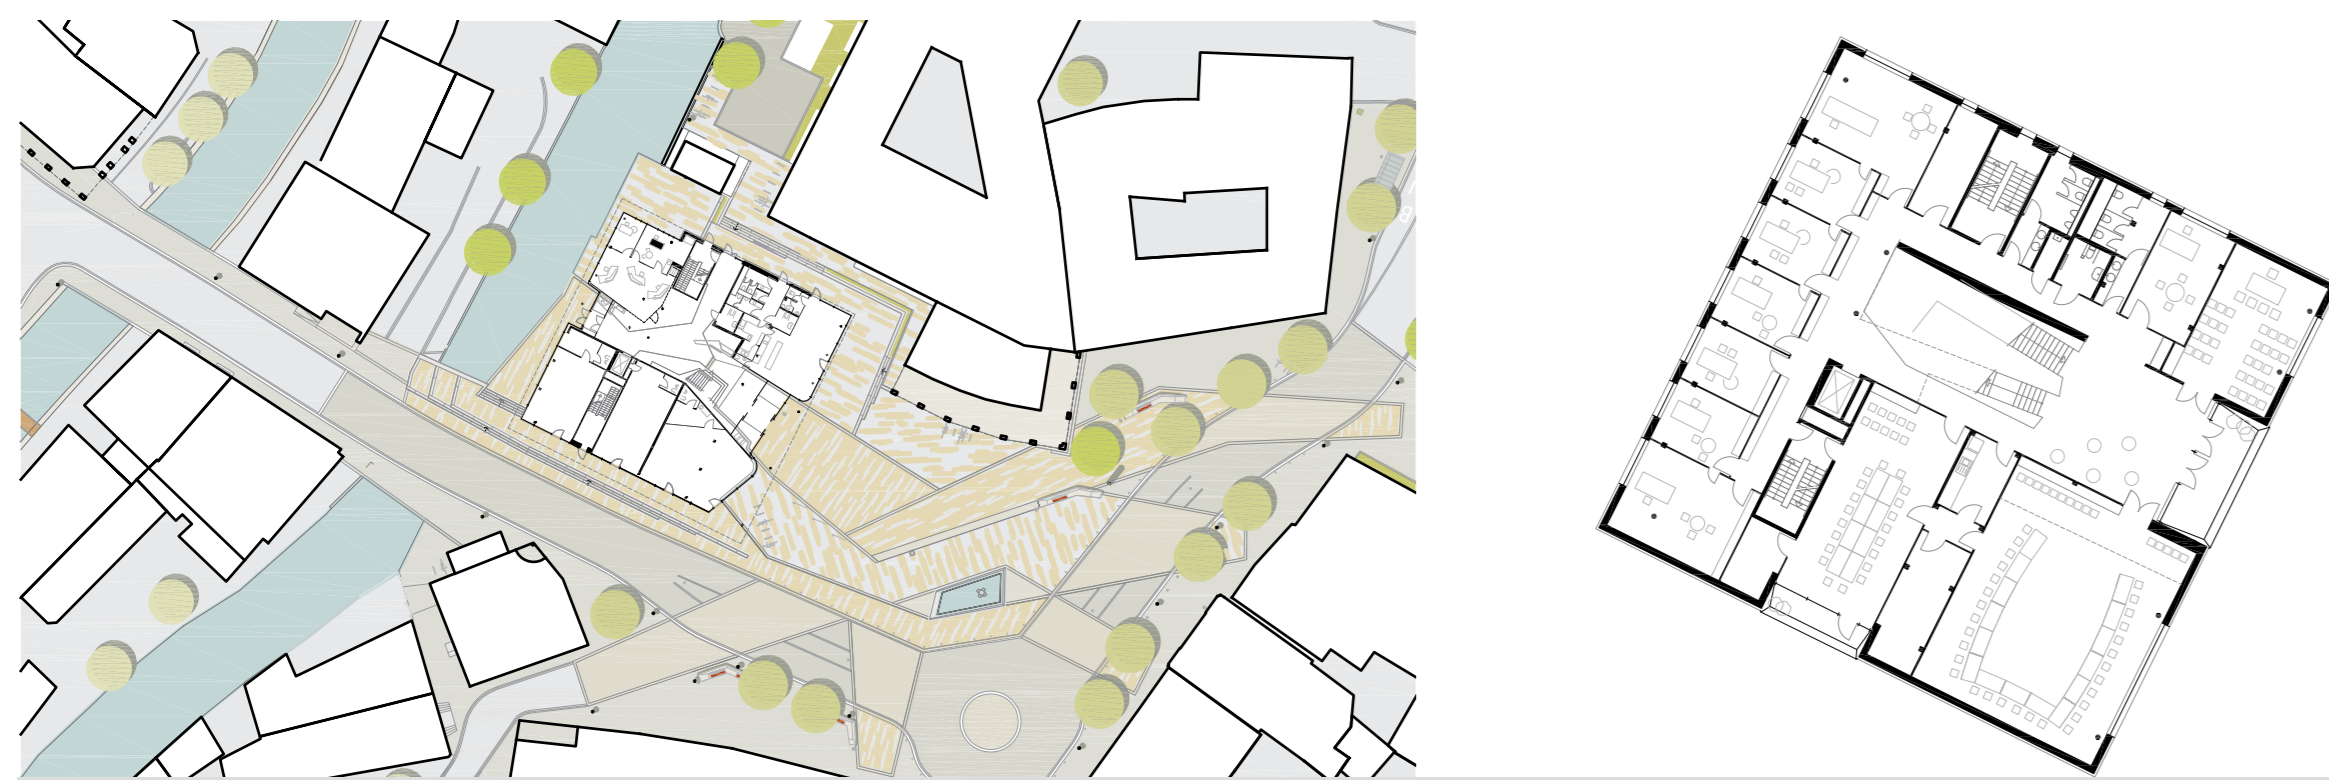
und 2: Lageplan und Grundriss des 2.OG des Rathauses - Bad Aibling
